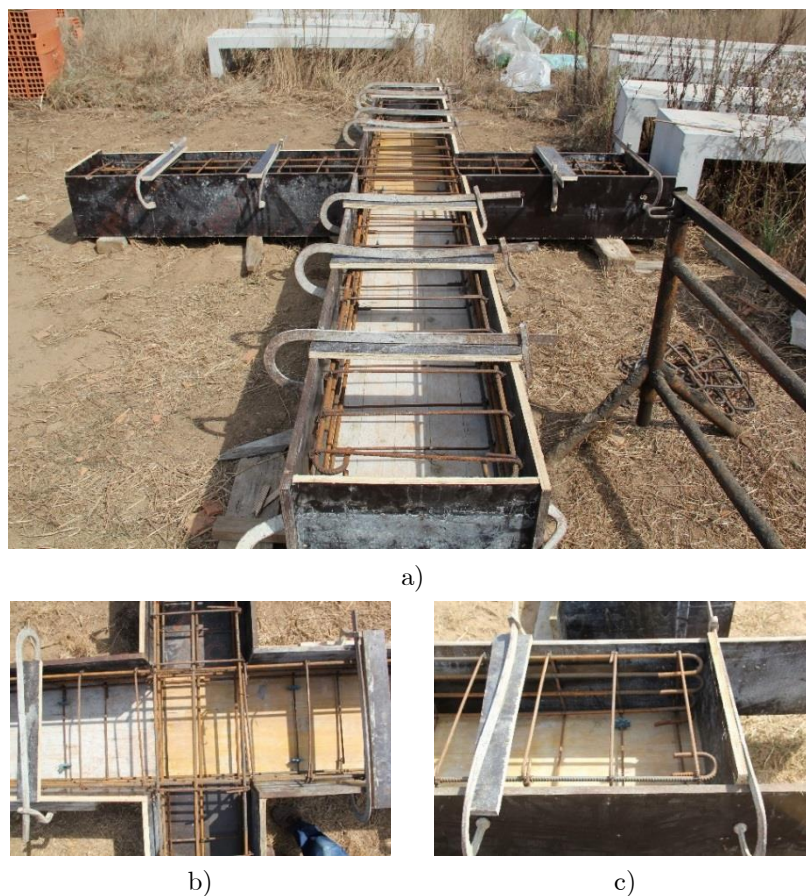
Detalhes da cofragem dos provetes: a) Vista geral da cofragem; b) Zona de ligação do nó; c) Pormenor dos espaçadores em PVC.
